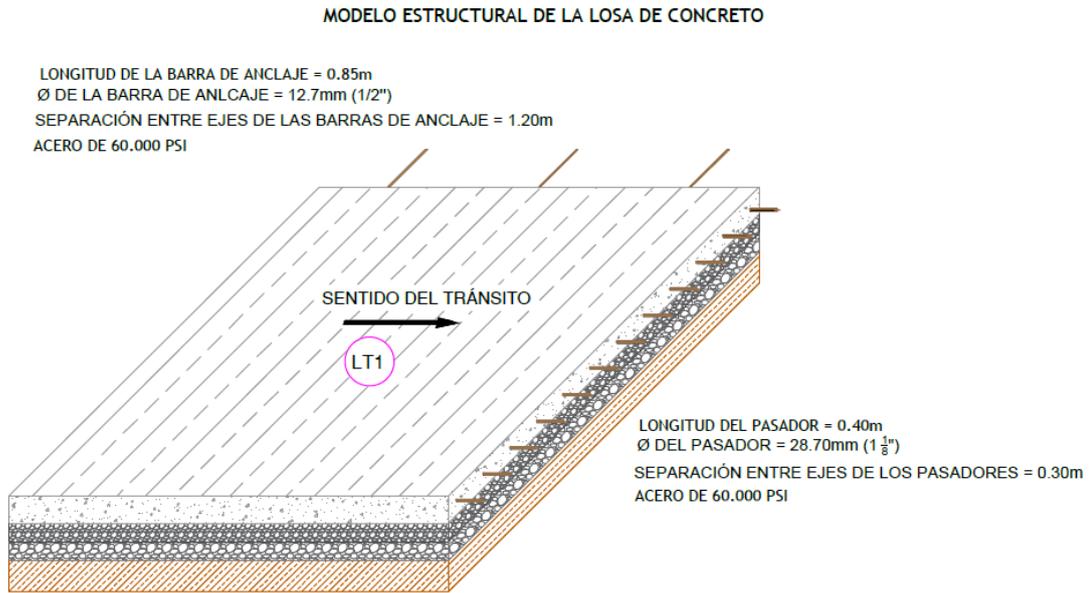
Modelo tridimensional de la estructura de pavimento. Elaboración Propia
